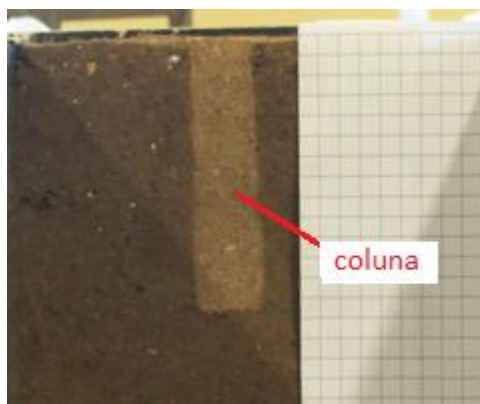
Foto da escavação da caixa 4: coluna executada com pilão tipo B
